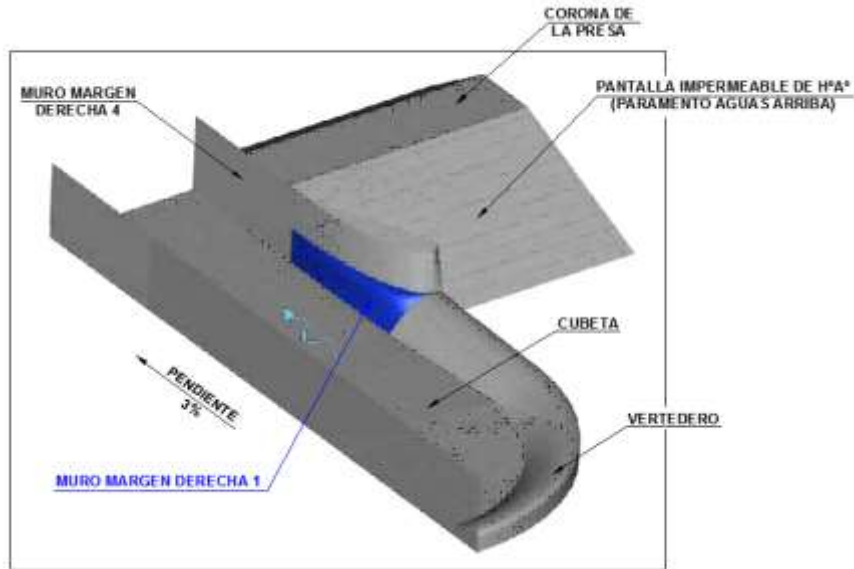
Muro margen derecha 1 vertedero de excedencias
